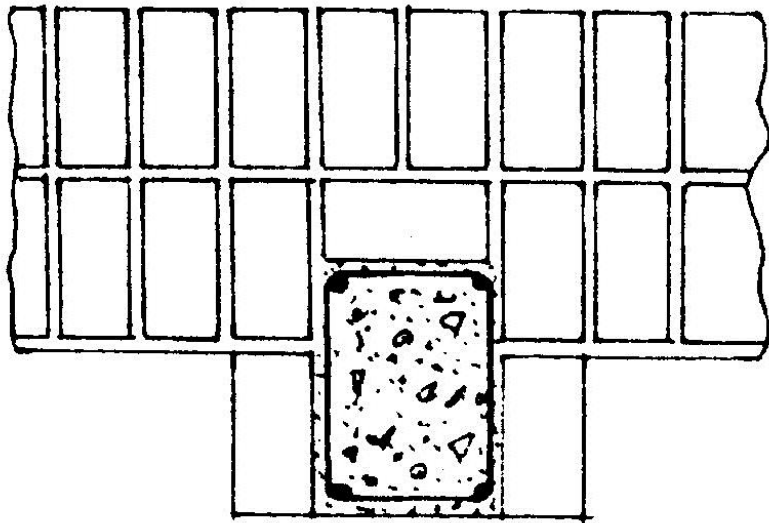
Продольное армирование кирпичных конструкций (стен, столбов и др.):
